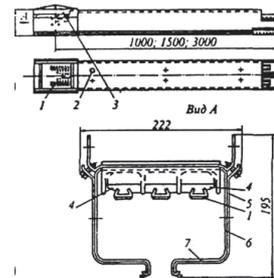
Троллейный шинопровод типа ШТМ: а – общий вид; б – поперечный разрез; 1 – троллей; 2 – крепление изолятора; 3 – серьга подвески; 4 – изолятор; 5 – короб; 6 – корпус соединительной муфты; 7 – уступ короба
